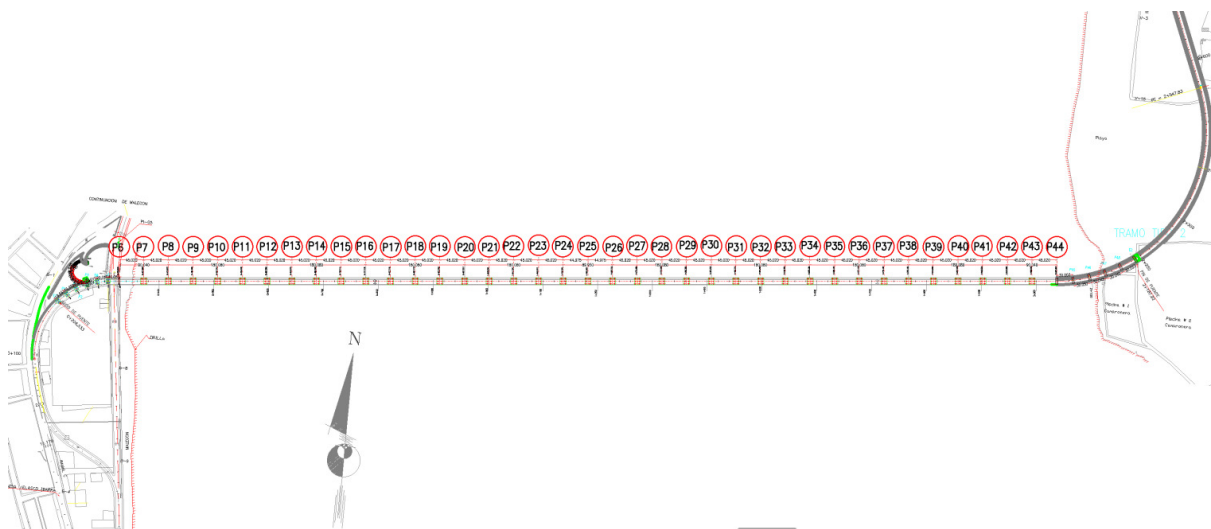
Distribución de las Pilas existentes en el Puente “Los Caras”
